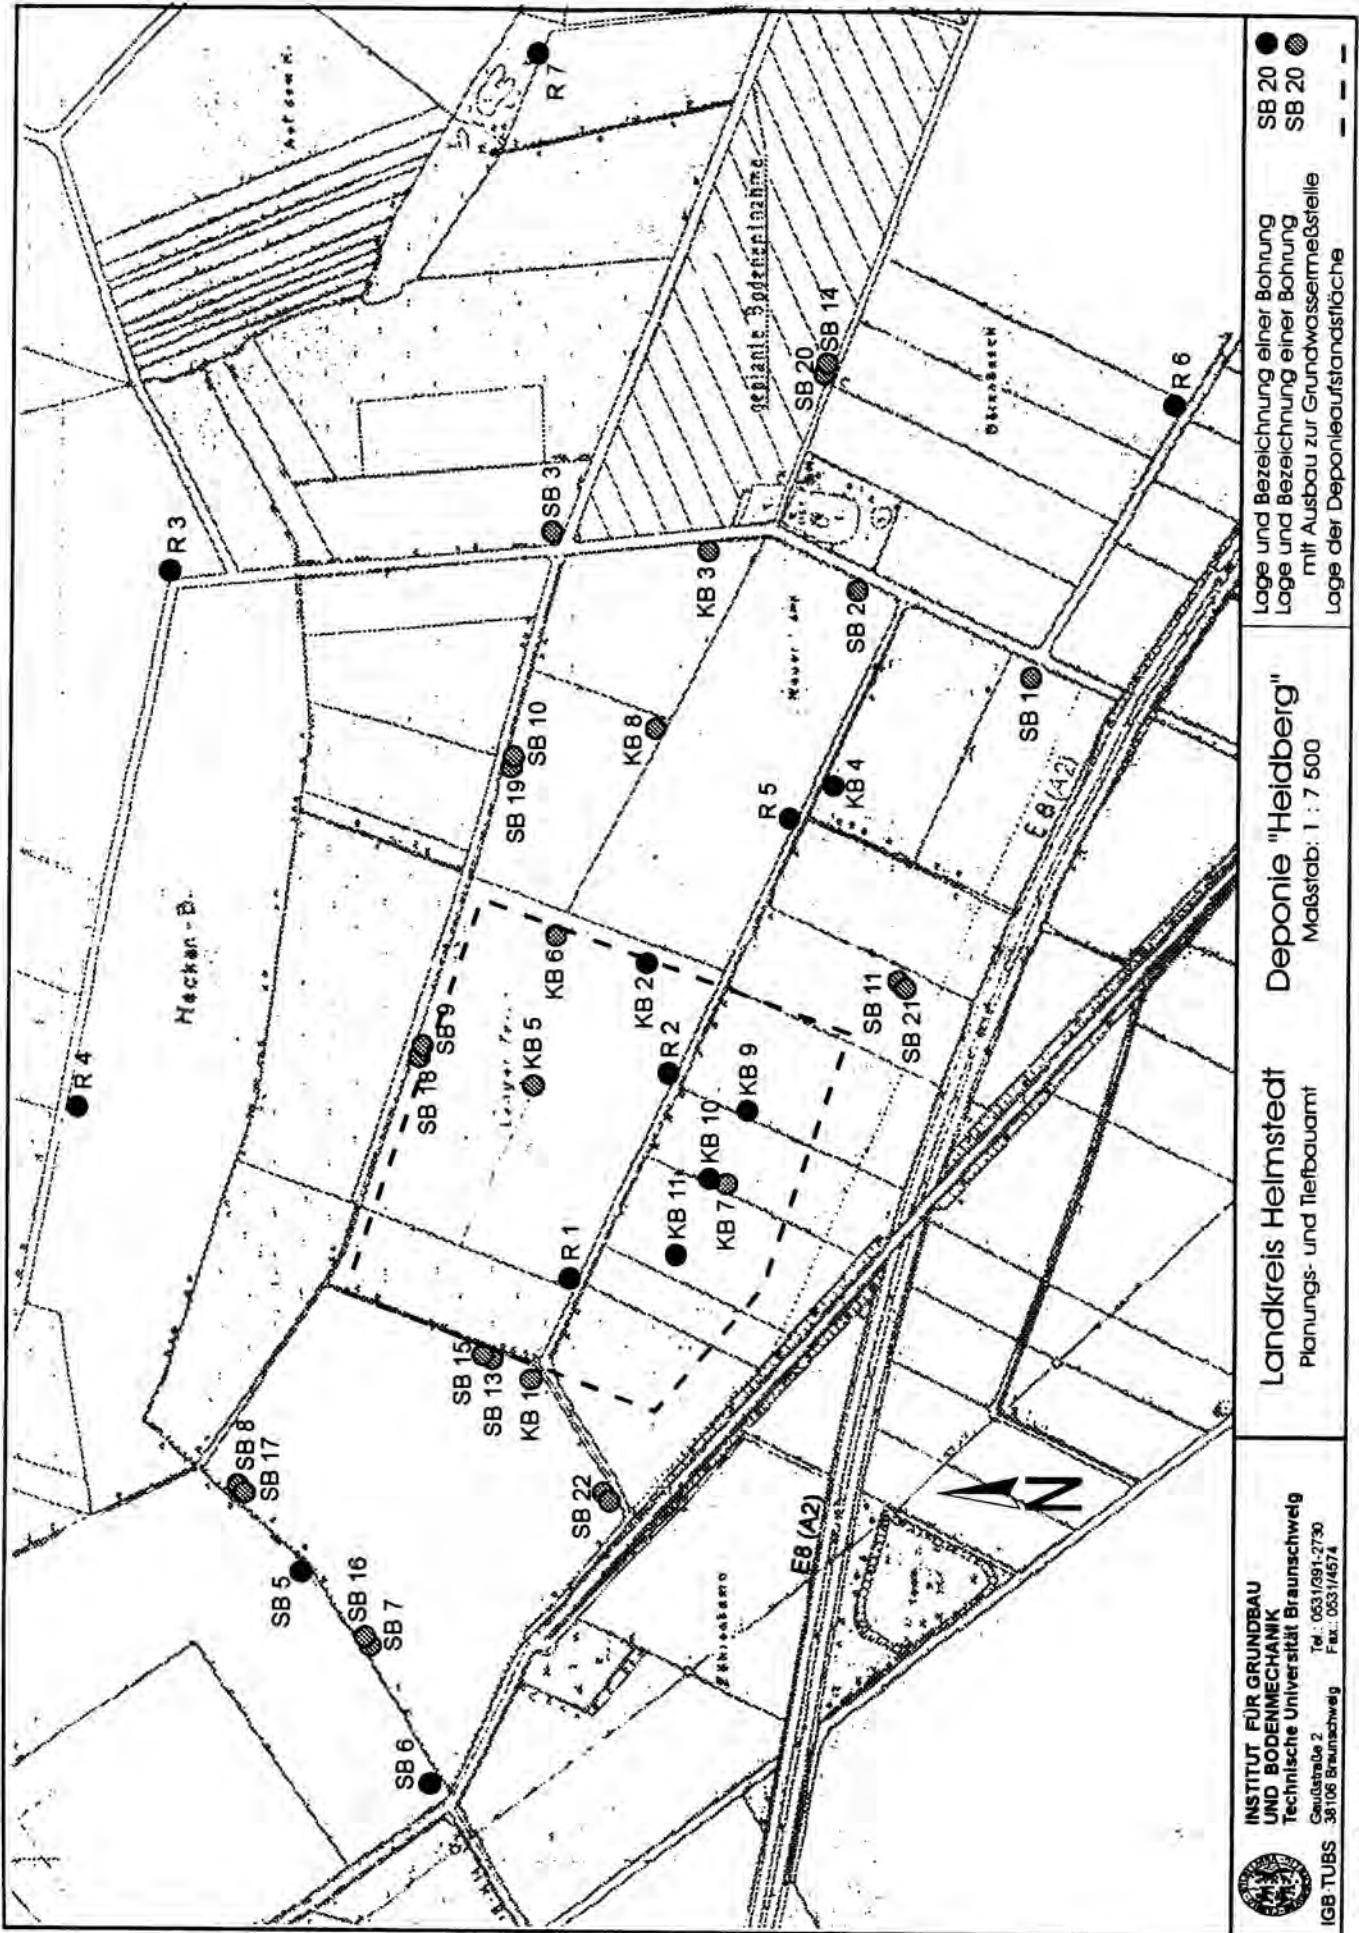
Übersichtsplan mit Lage der Brunnen bzw. Grundwasserbeobachtungsstellen
